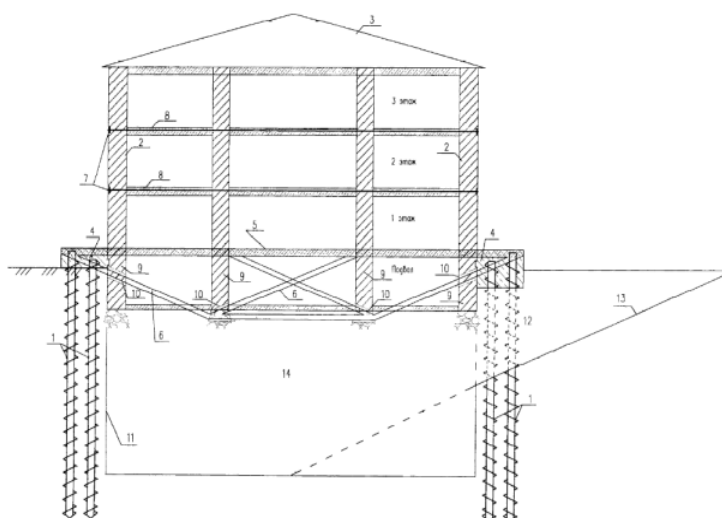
Схема устройства подземного этажа по патенту 2431718: 1 – одинарный либо двойной ряд свай; 2, 3 – здание; 4 – сложный ростверк; 5 – ж/б плита; 6 – стержни ферм; 7 – пояса усиления; 8 – перекрытия; 9 – стена подвала или цокольного этажа; 10 – отверстия для стержней ферм; 11 – объем подземного объекта; 12 – порталый проем; 13 – пандус; 14 – грунт
